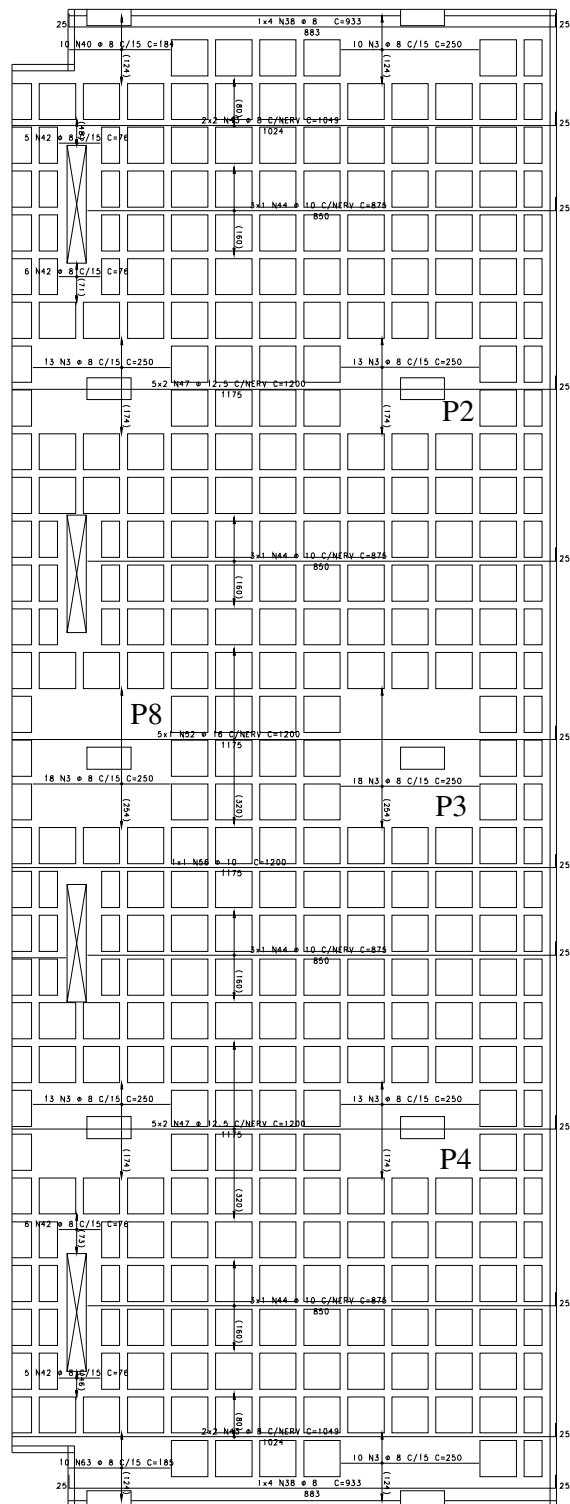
Armadura positiva transversal (Primeiro Exemplo)
